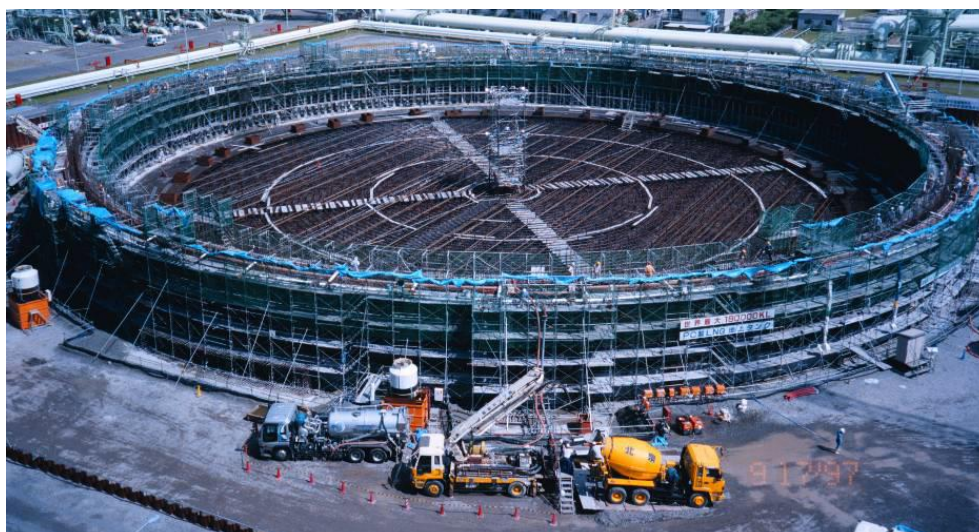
Vista geral do local de construção durante a betonagem.
